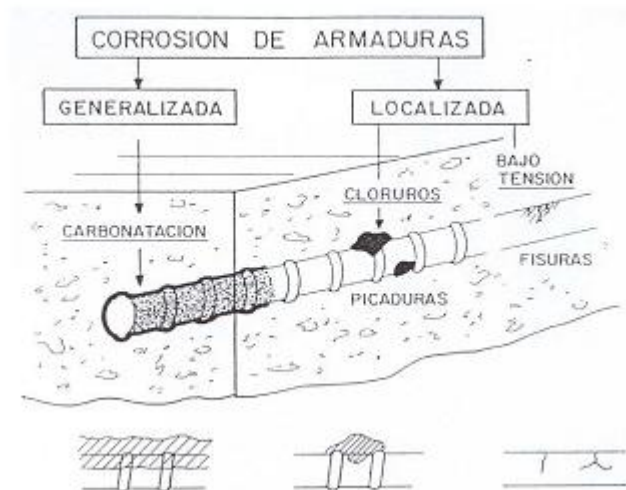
Tipos de corrosión de armaduras en el hormigón [18].
